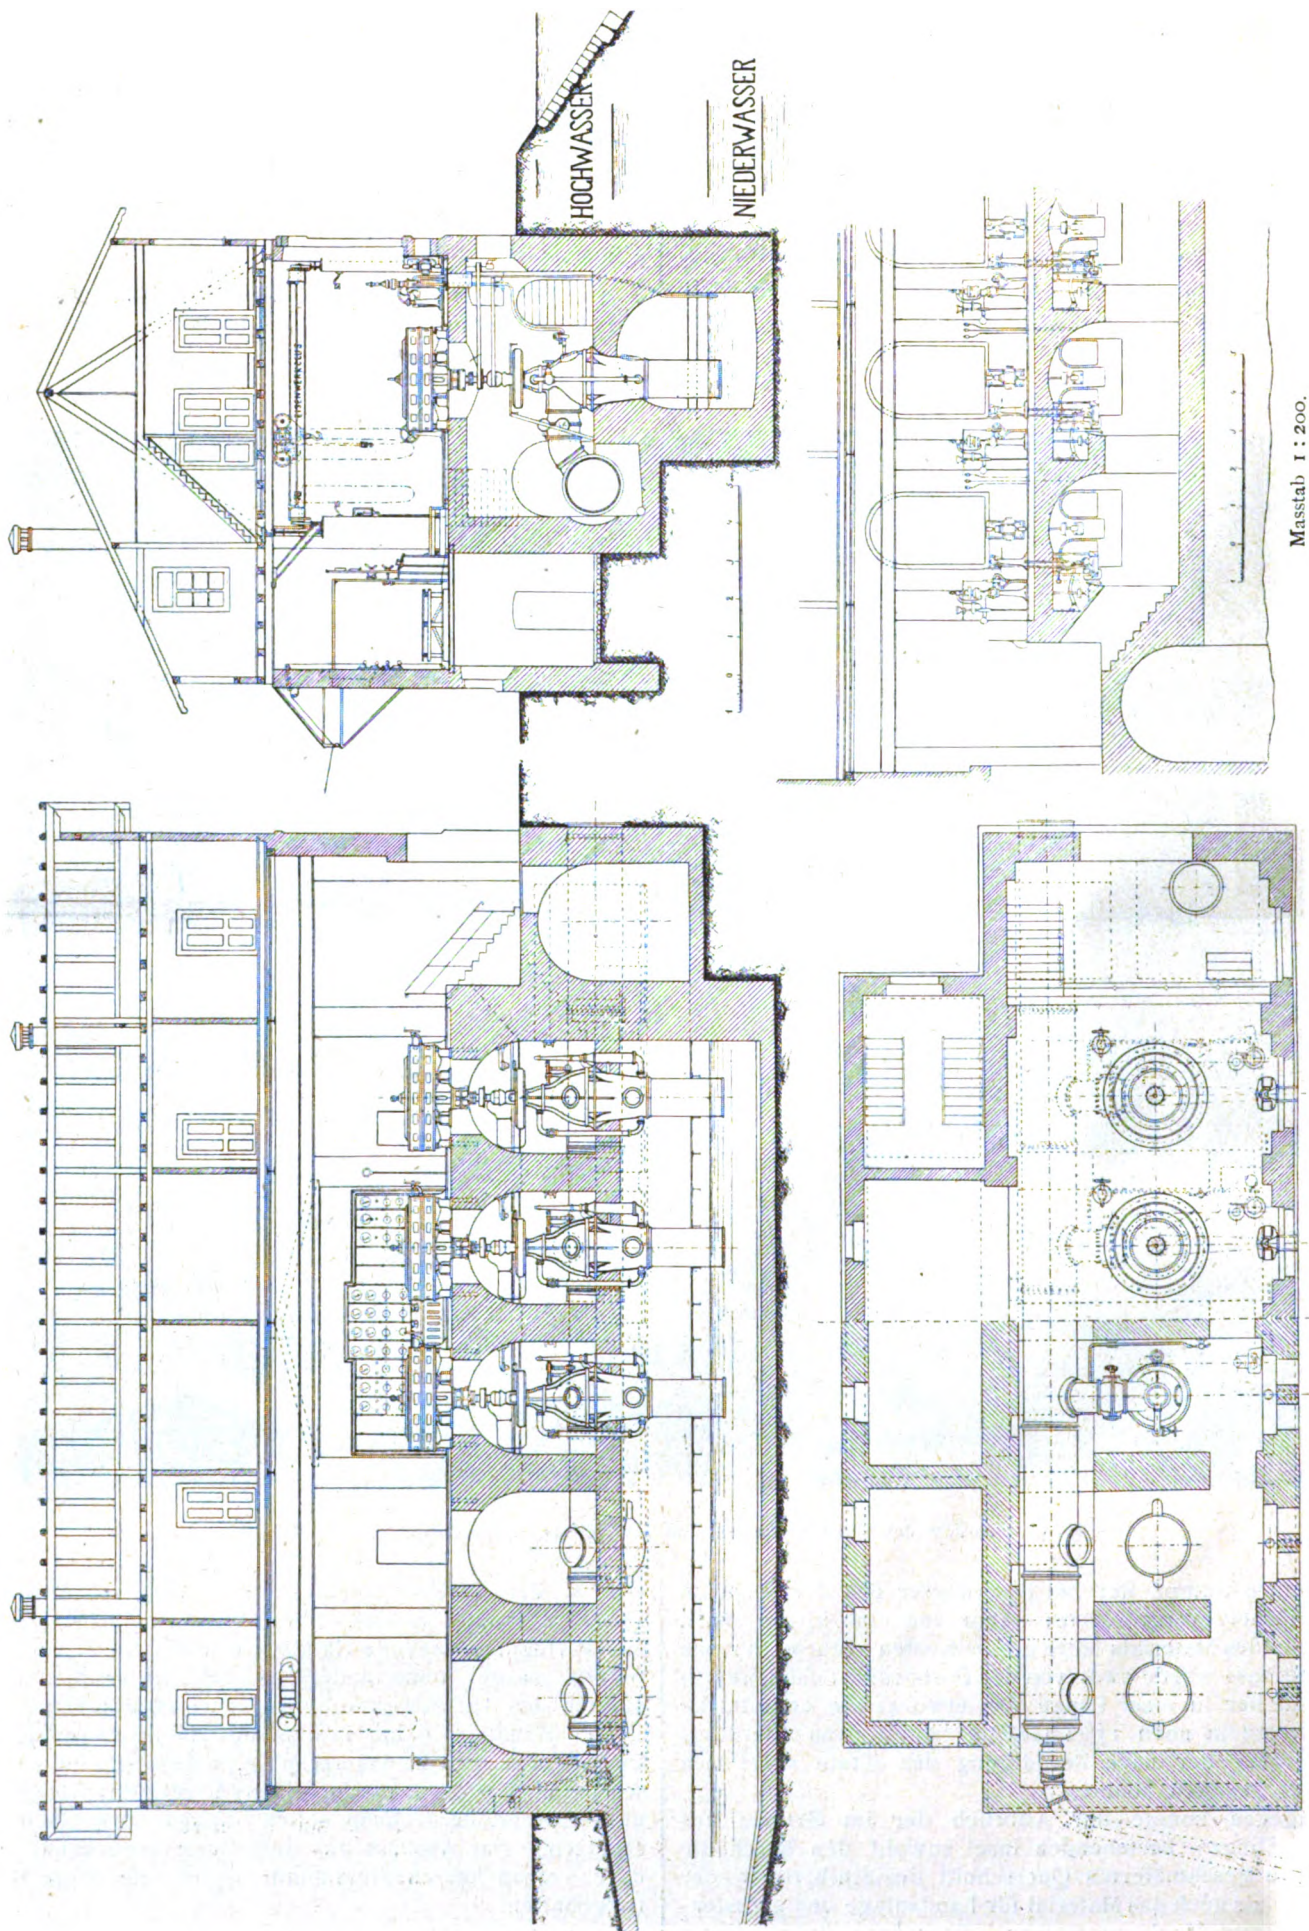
35. Schnitte und Grundriss des Maschinenhauses.
